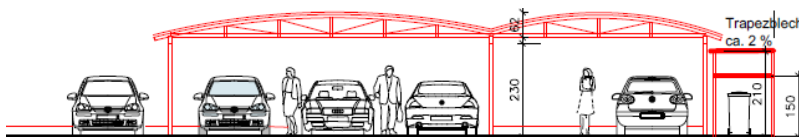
Carport Grundriss; Quelle Ausschnitt aus Einreichplan Stand 29.10.2019
